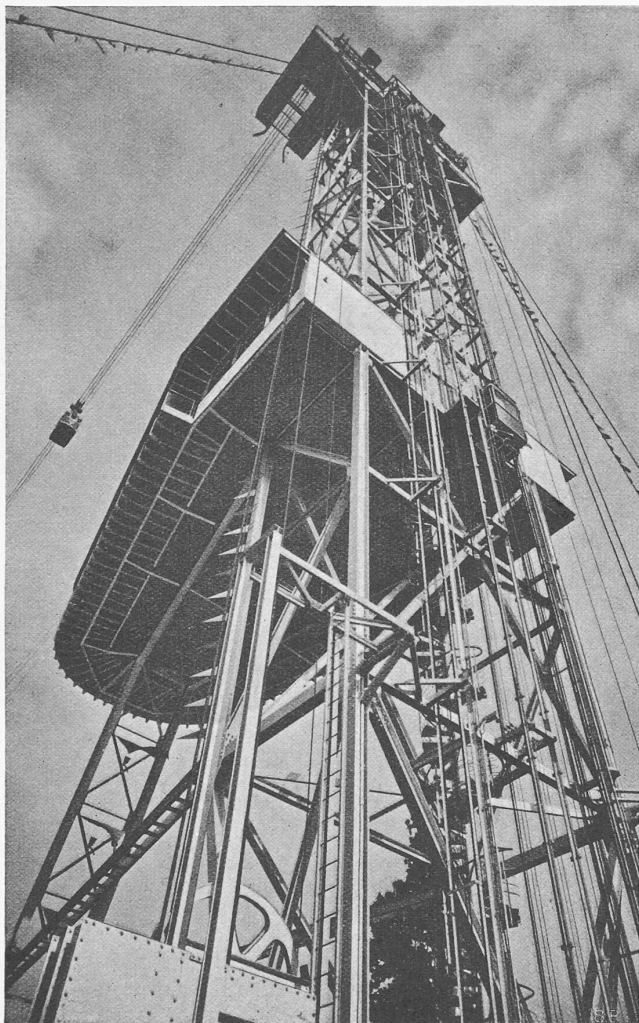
Linksufriger Turm, Rückansicht mit den Aufzugschächten
